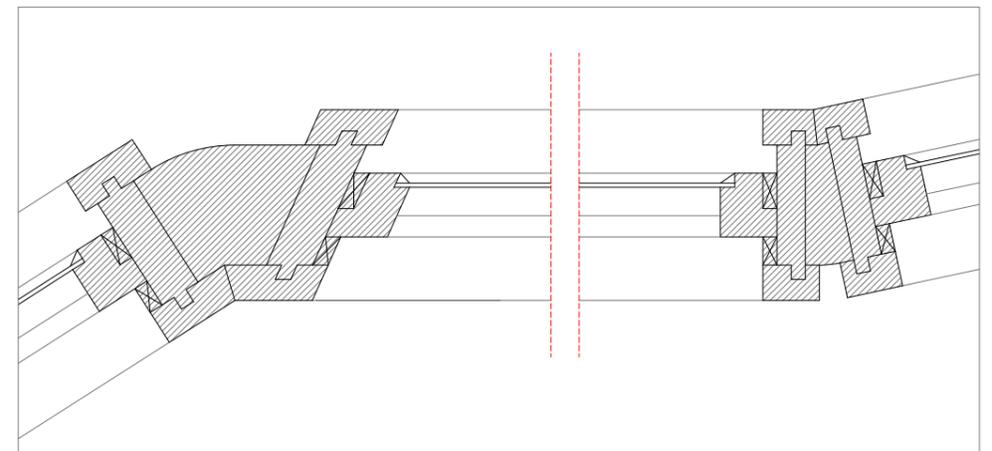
Planta de Caixilharia Existente da Parede-cortina | Escala 1:5
